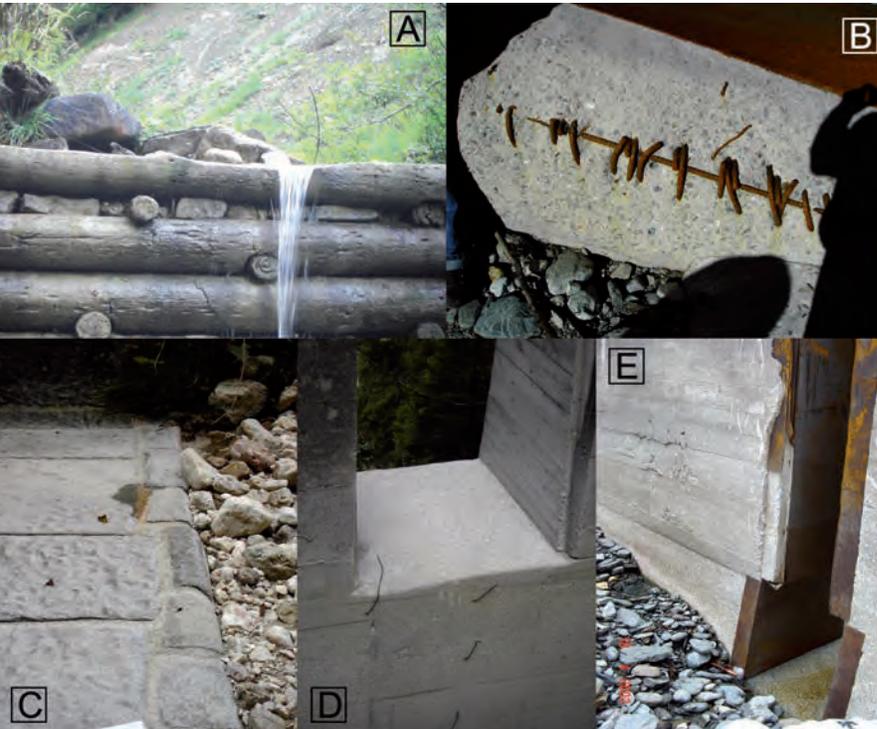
Abrasion mit hohem schleifendem Anteil: (A) Abrasion auf Holz; (B) Abrasion an einer Stahlbetonkrone mit freigelegter Bewehrung; (C) Abrasion von Kronsteinen aus Granit; (D) Abrasion einer Öffnung in einer Stahlbetonsperre; (E) schlagende Abrasion an einem Kantenschutz aus Stahl (GBL Pinzgau)
